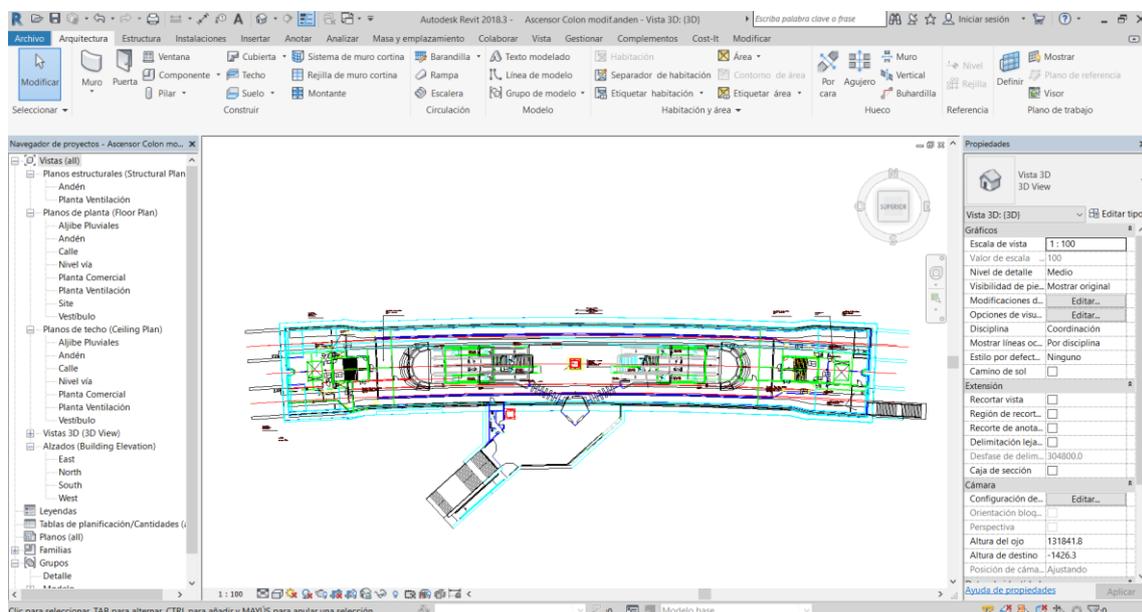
Vista en planta de todos los niveles importados de las plantas de la estación de Colón.
